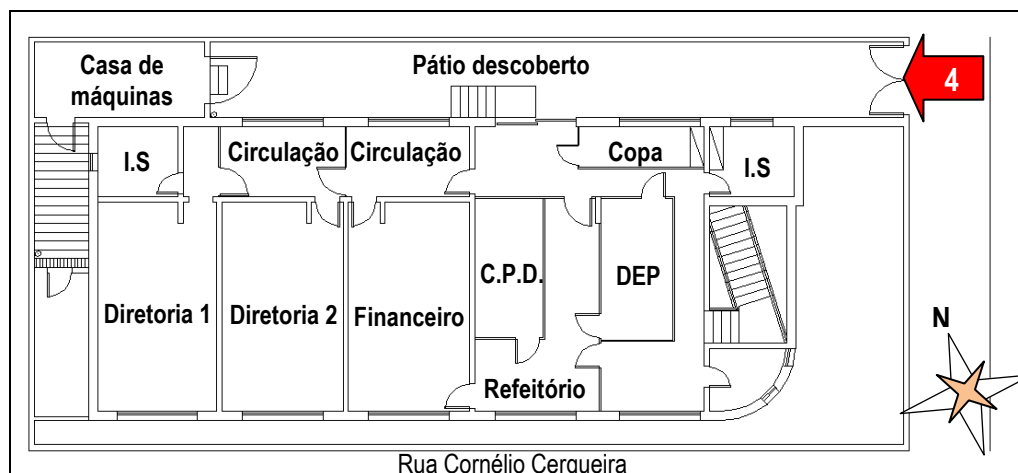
Acessos ao empreendimento (2º Pavimento)
